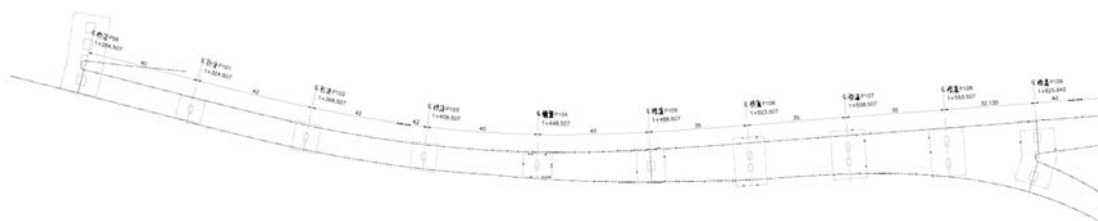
和美交流道匝道一高架橋平面圖單元一與二
